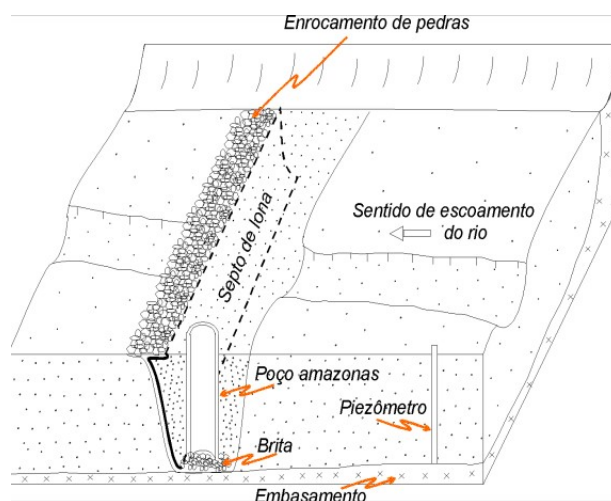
Ilustração do modelo Costa e Melo de barragem subterrânea
